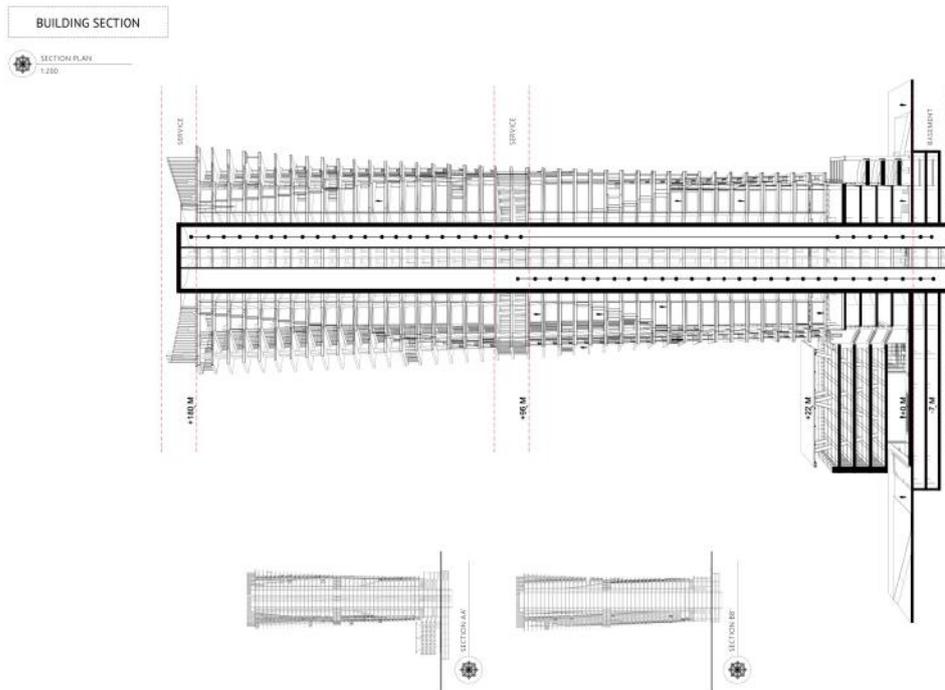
Denah Tower Apartemen. Sumber: Dok.Prbadi
